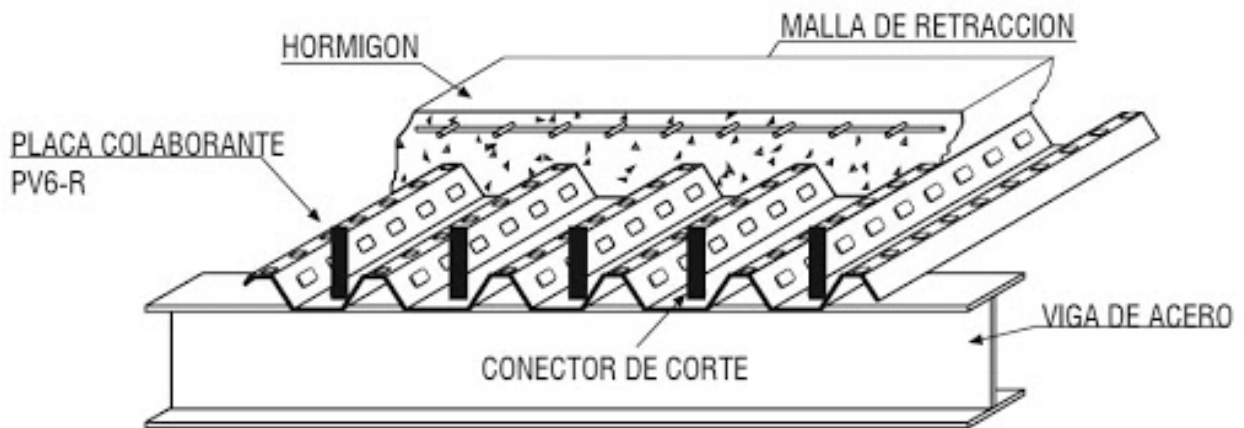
Losa acero, sistema constructivo. <http://jolmos.es/blog/forjado-colaborante/>
